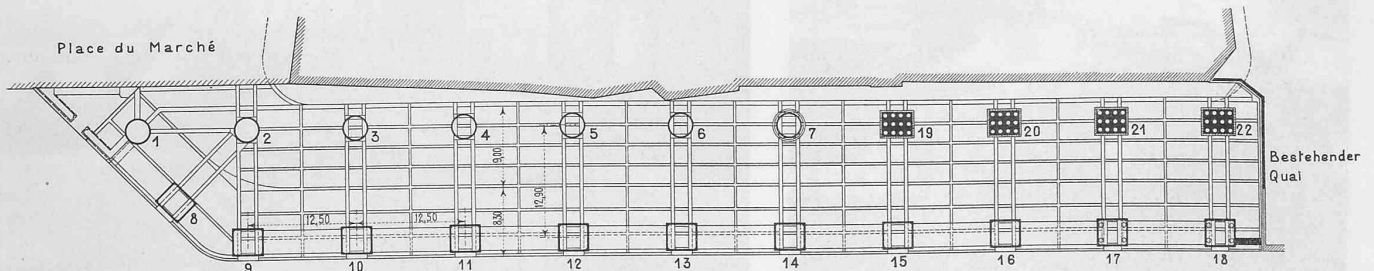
Lageplan des neuen Quai Perdonnet in Vevey. — Masstab 1 : 800.
